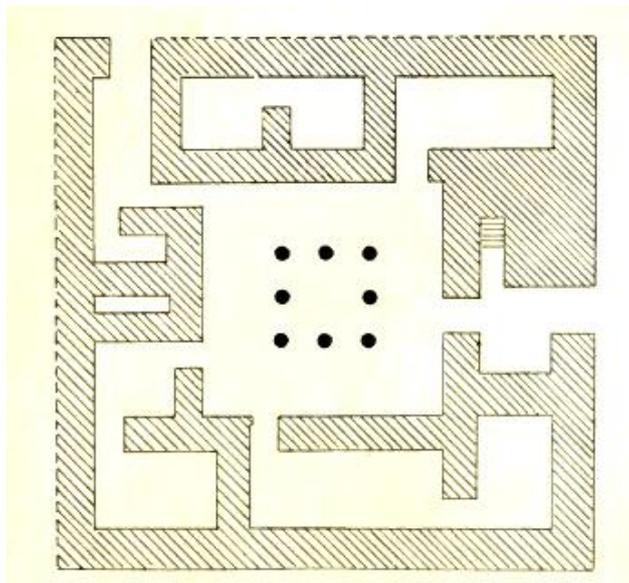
Planta de M251-253 (GARSTANG 1912: pl. VII).
